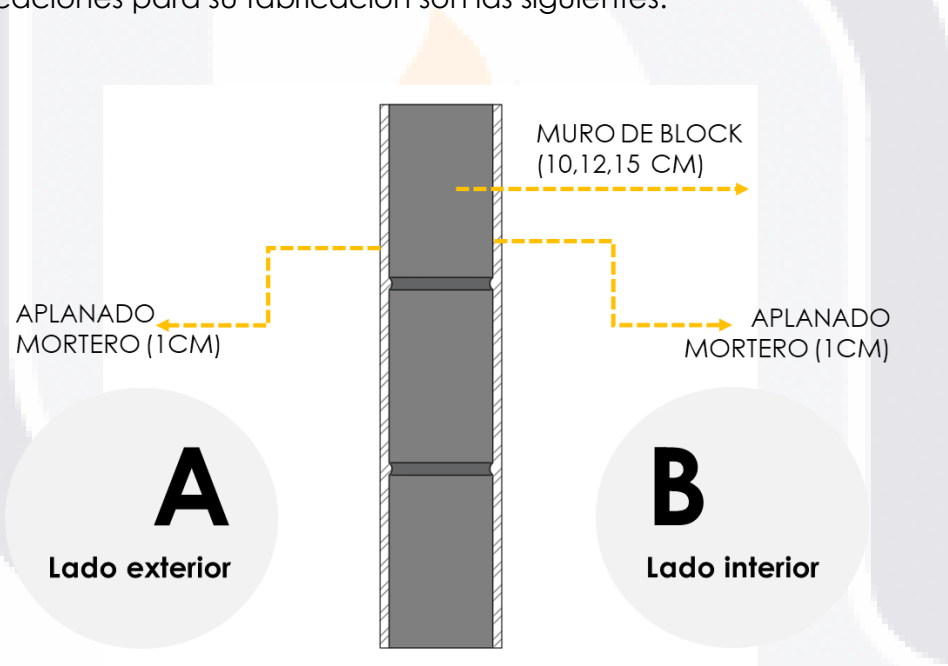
Detalle para fabricación de muros sin recubrimiento. Fuente: autoría propia
